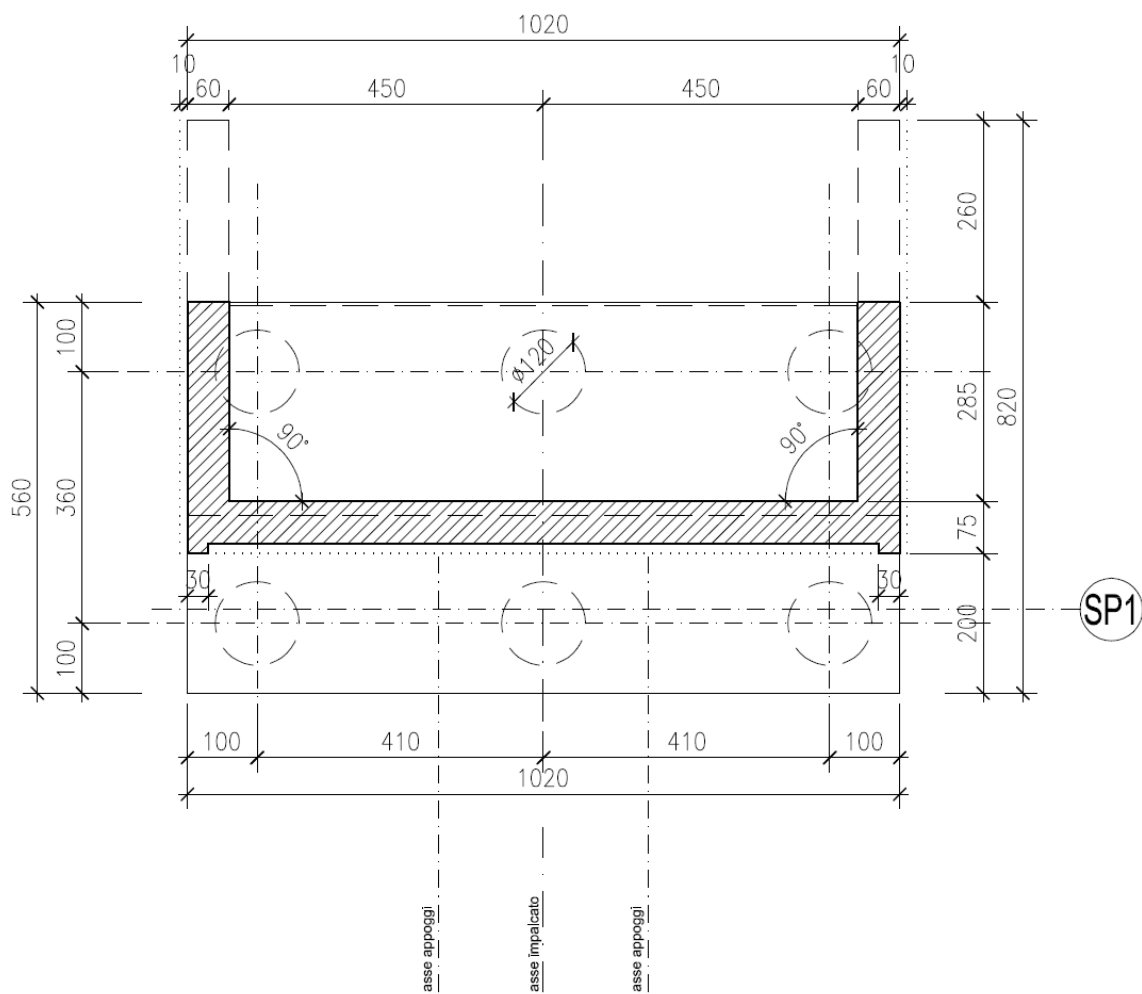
PIANTE FONDAZIONE SPALLA
